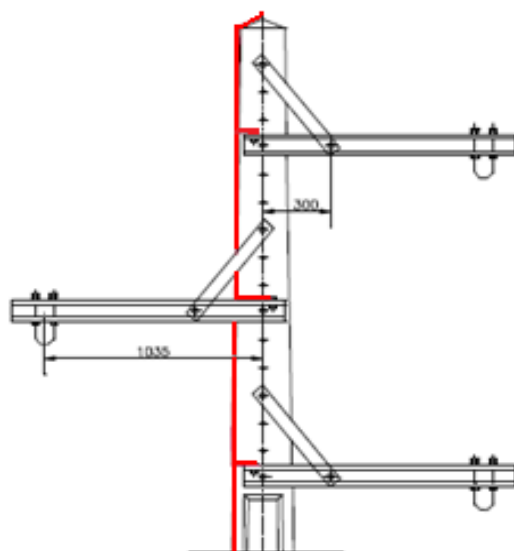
Ligação à terra da armação de um poste de betão [4]
